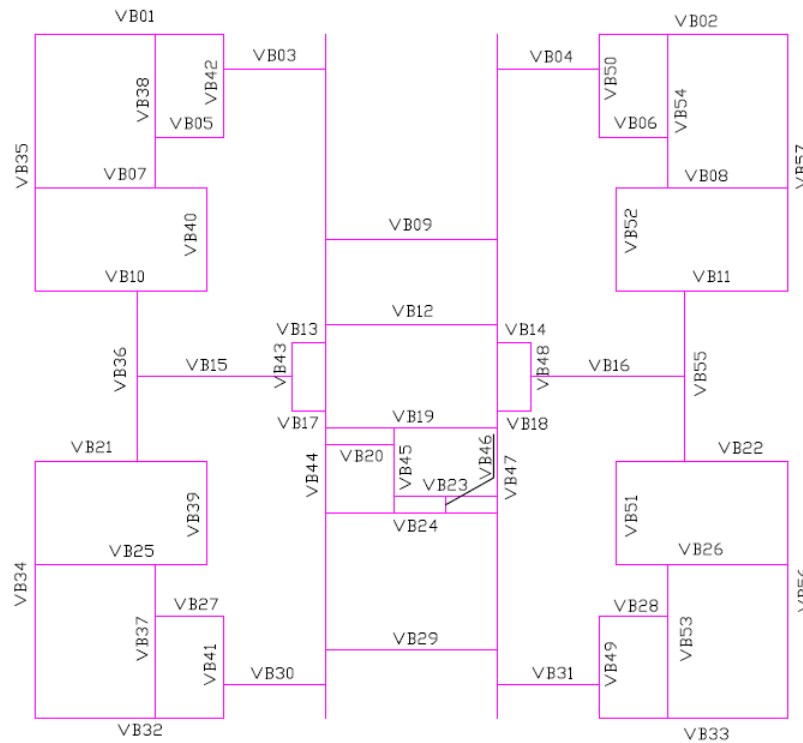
Vigas baldrame do edifício quadrado com fundação rasa.
